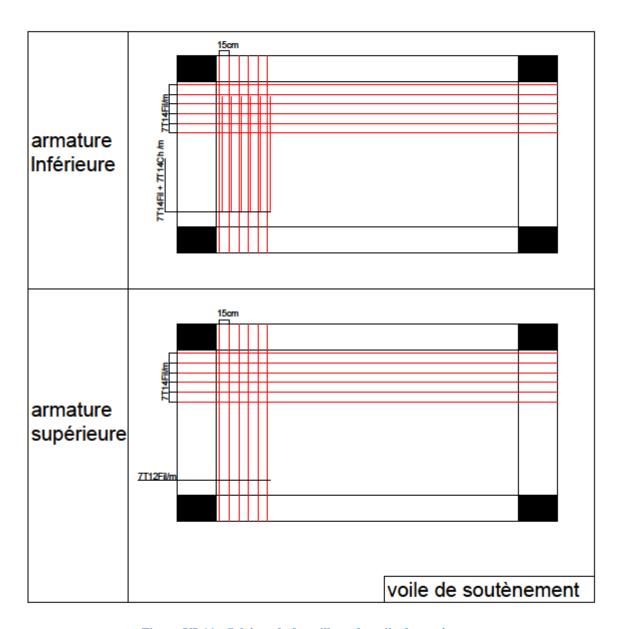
Schéma de ferraillage du voile de soutènement
